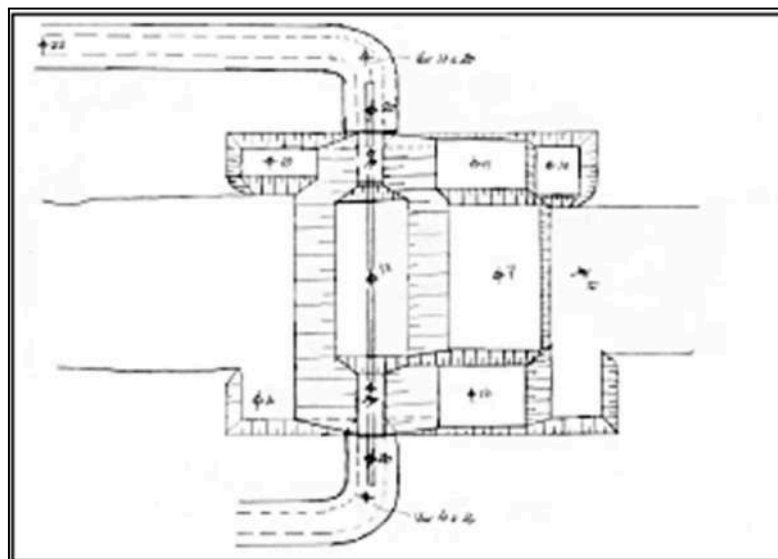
Planta del cierre de enrocado aguas abajo de la cascada. Alternativas del INA para el Arroyo Saladillo. (2018).
